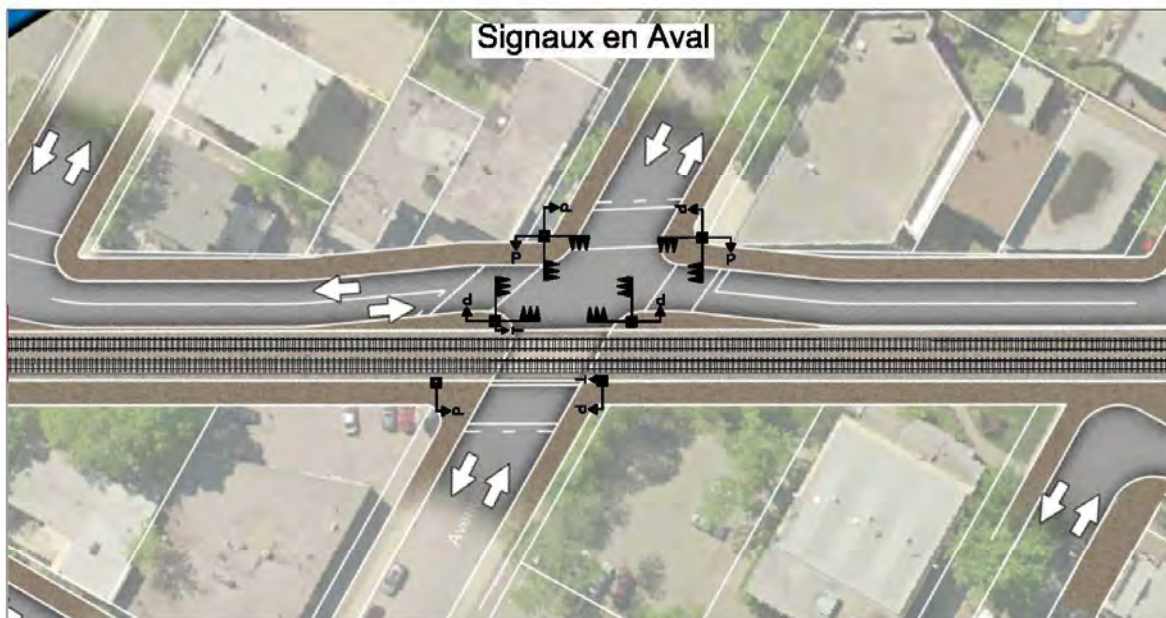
Disposition des signaux lumineux aux carrefours pour le tramway en site propre en position latérale – hors station – sans mail central
